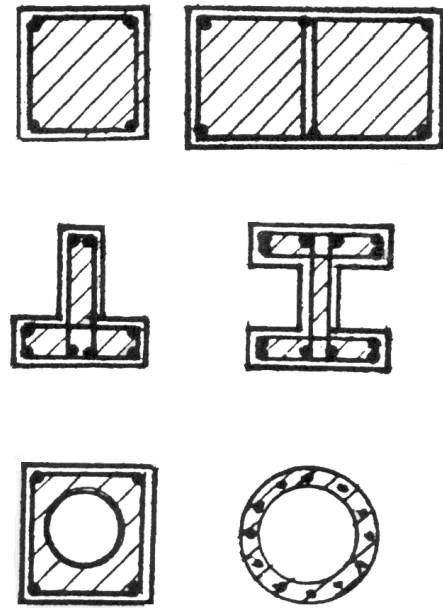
Форми перерізів залізобетонних палі:
